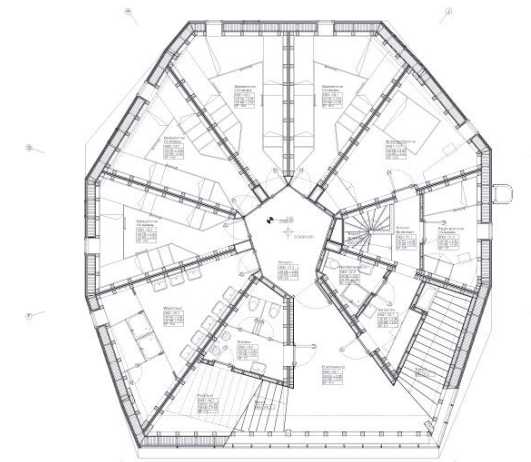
Pianta piano primo del Monte Rosa Hütte
